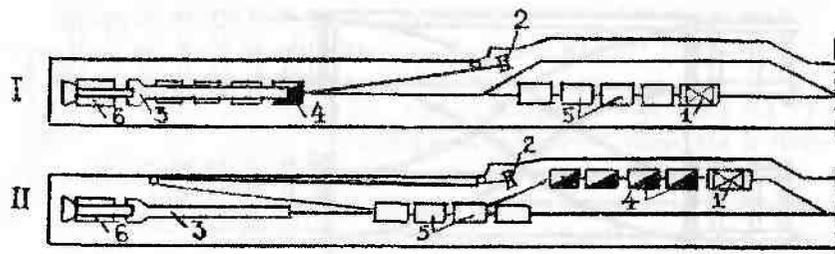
Схема обмена партий вагонеток с применением перегружателя на замкнутой разминке в однопутевой выработке
